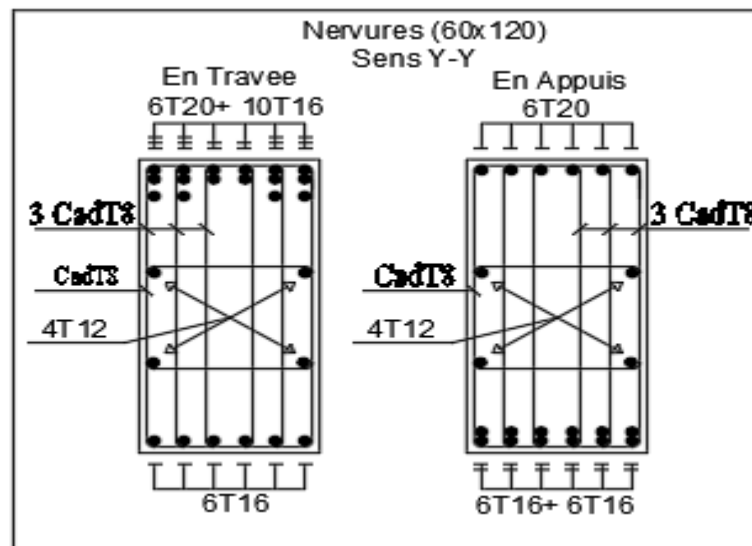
Ferrailage du panneau du radier sens y-y.
